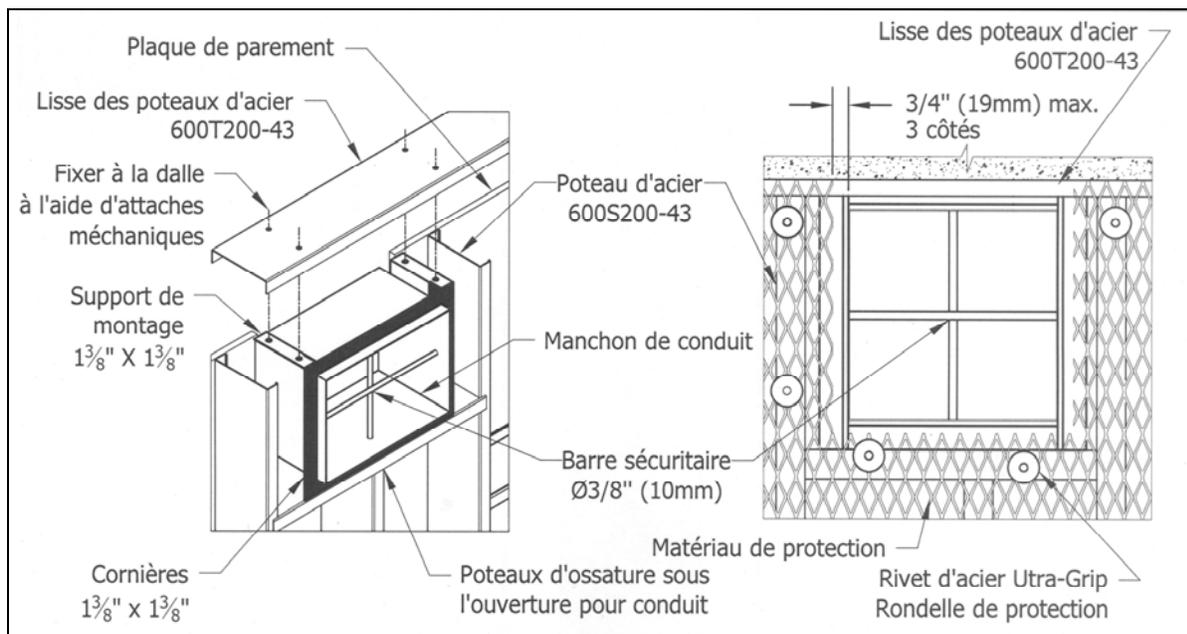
Ouverture pour conduit de ventilation monté au plafond
